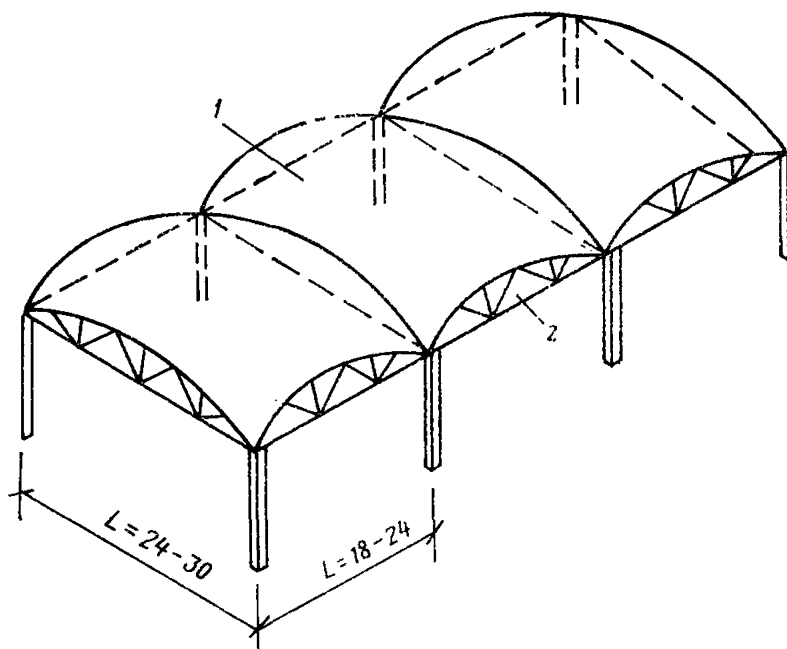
Схема сборно-монолитной оболочки покрытия
